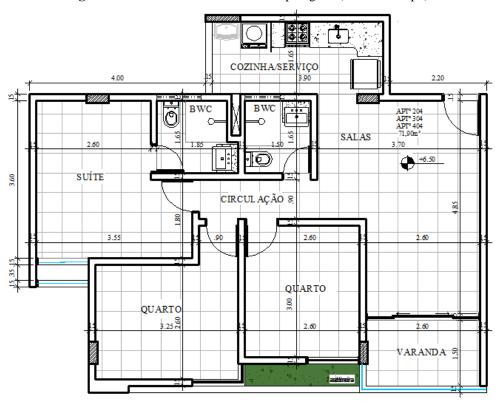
Planta Baixa de UHC de Tipologia 3 (Pavimento tipo)
